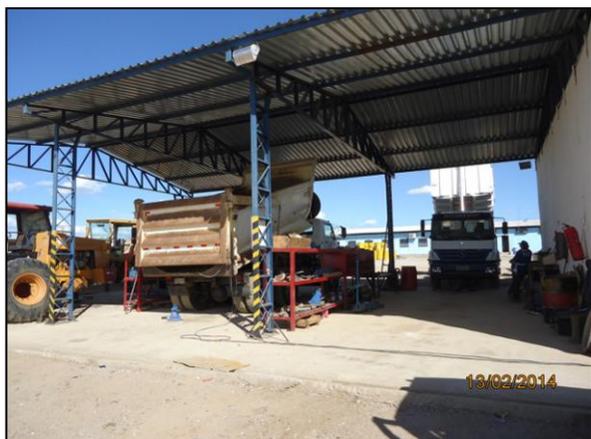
Oficina mecânica do canteiro de obras com piso impermeável e canaletas de drenagem em todo perímetro (fev/2014).
